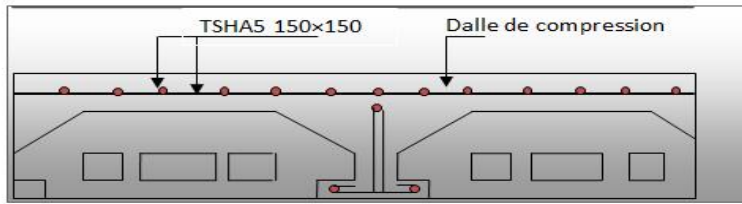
Schéma de ferrailage de la dalle de compression.
